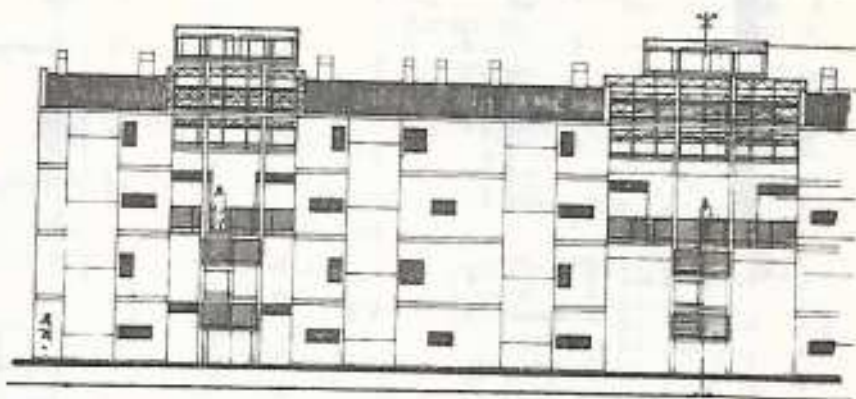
Fachada parcial Sur sub-conjunto 3
